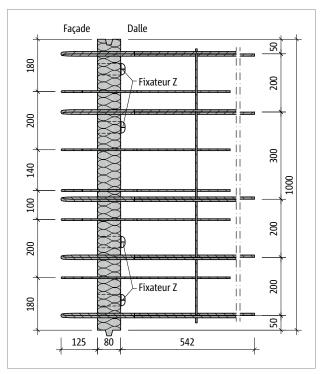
Schöck Rutherma® T type DFi-V4-LR125 : vue en plan du produit
